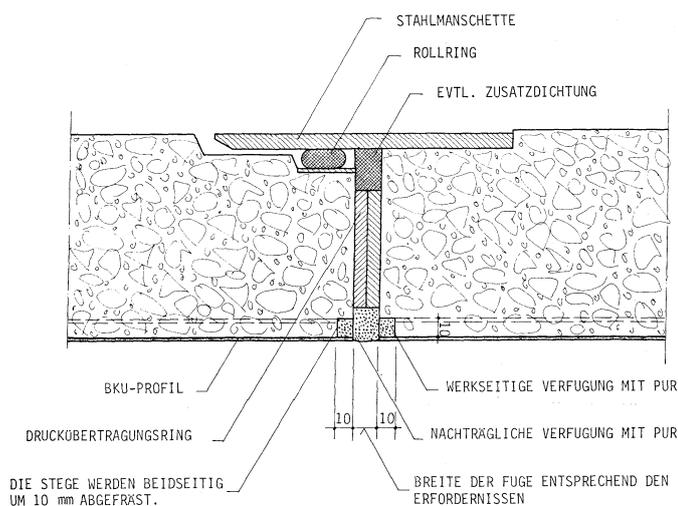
BKU-Vortriebsrohr (Rohrverbindung mit nachträglicher Verfugung) [25]
